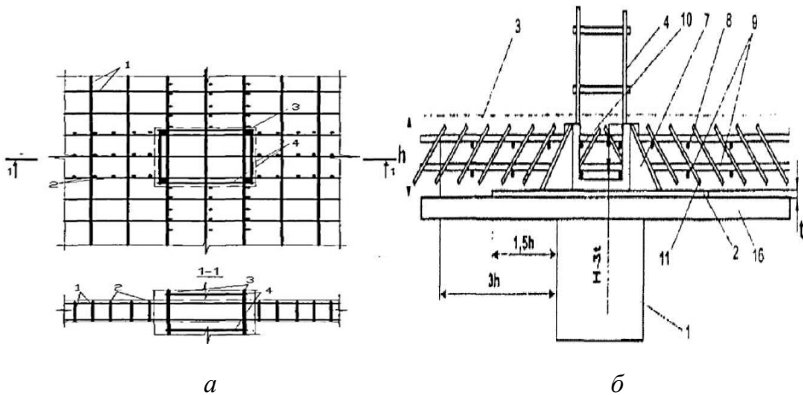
Армування вузлового з'єднання «плита-колонна» поперечною арматурою: а) вертикальною; б) похилою
